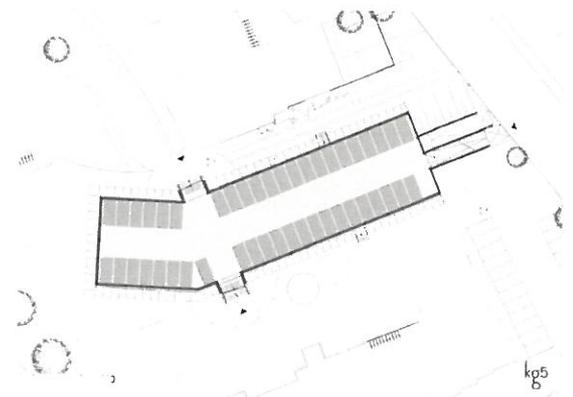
Grundriss UG (© kg5 Architekten)
